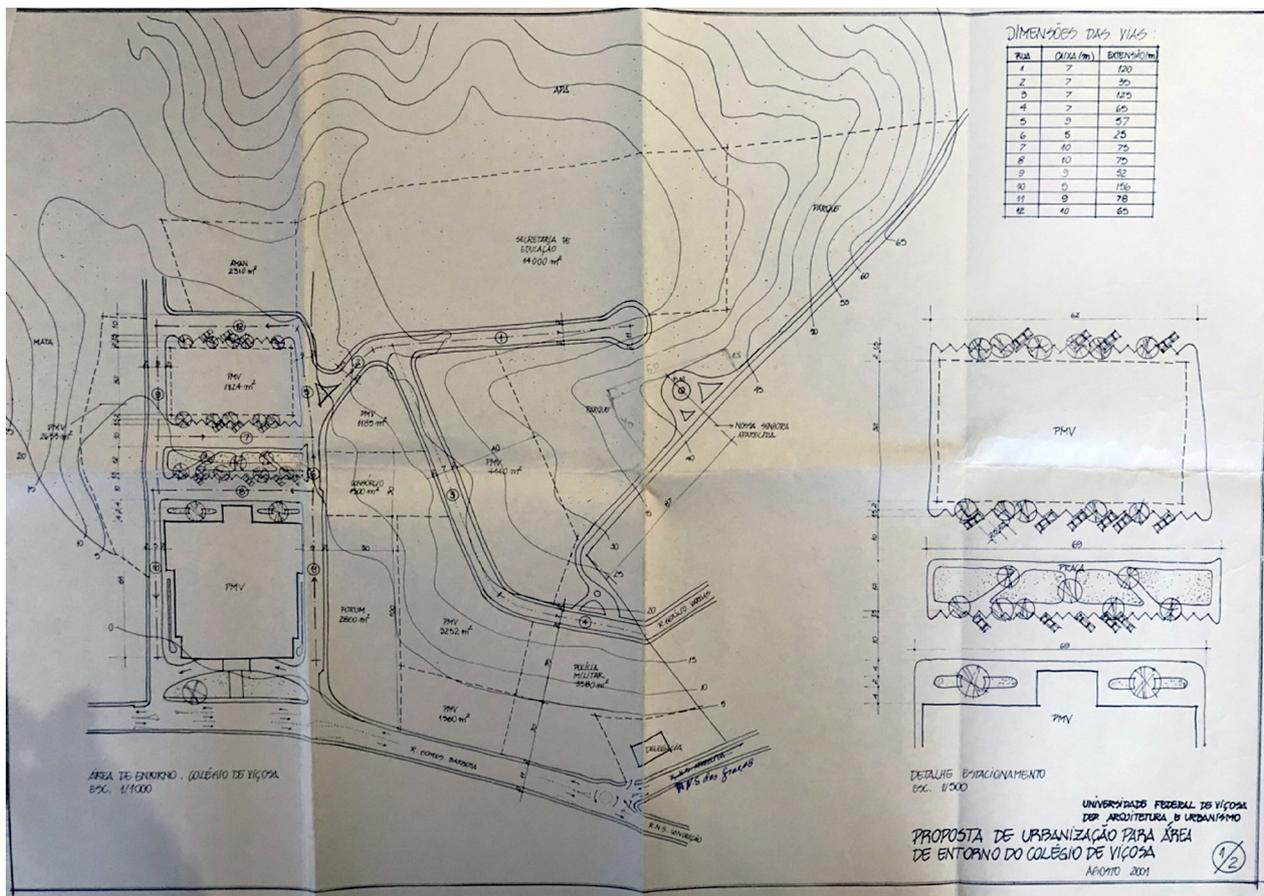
Planta elaborada pelo engenheiro civil Moisés Tomás da Silva. Outubro de 2001.
